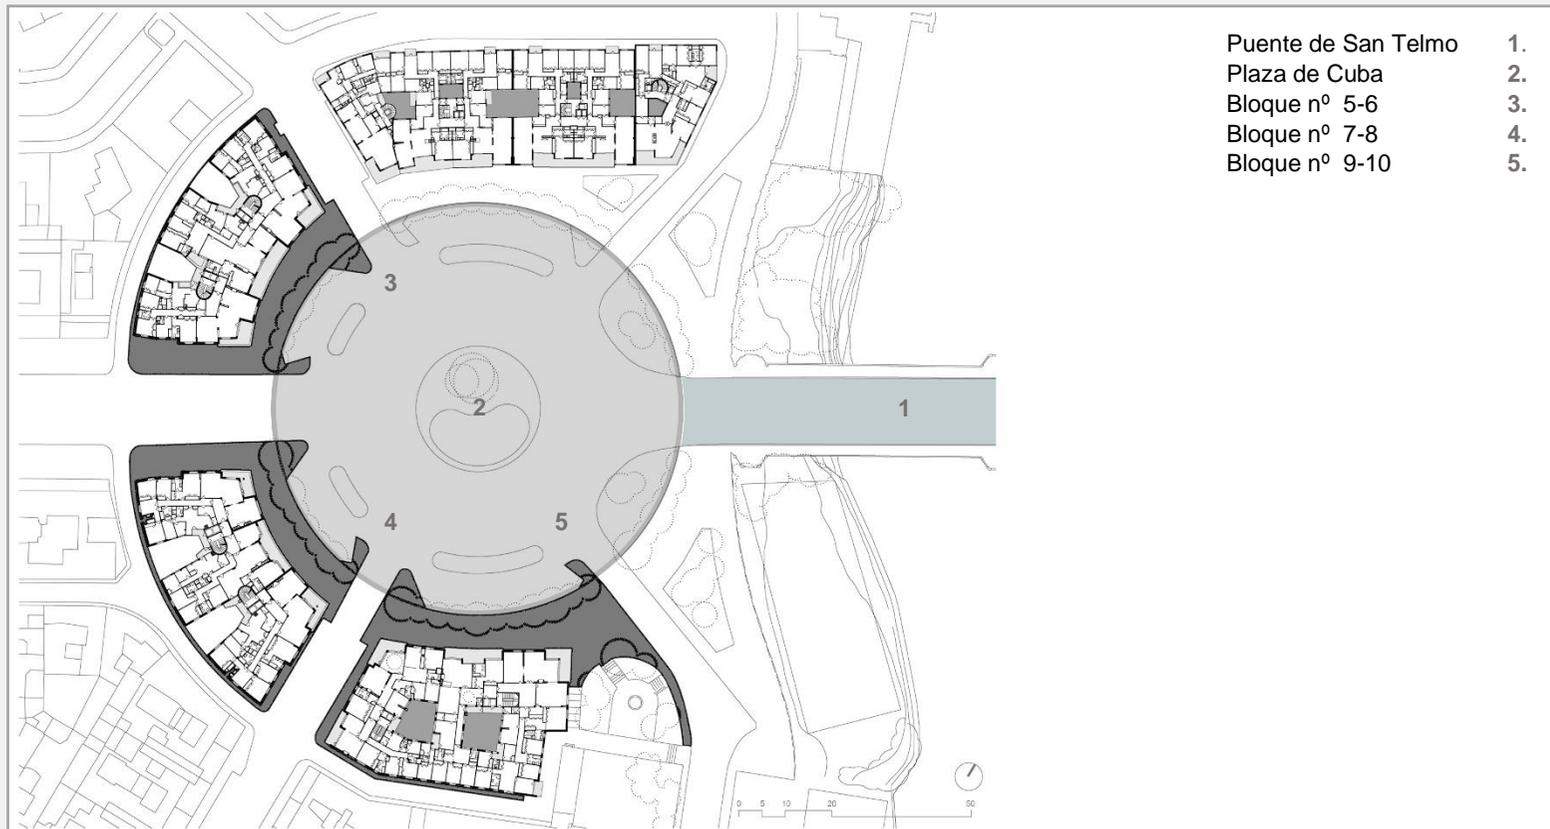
Grandes Bloques para la Plaza Cuba. Emplazamiento.
